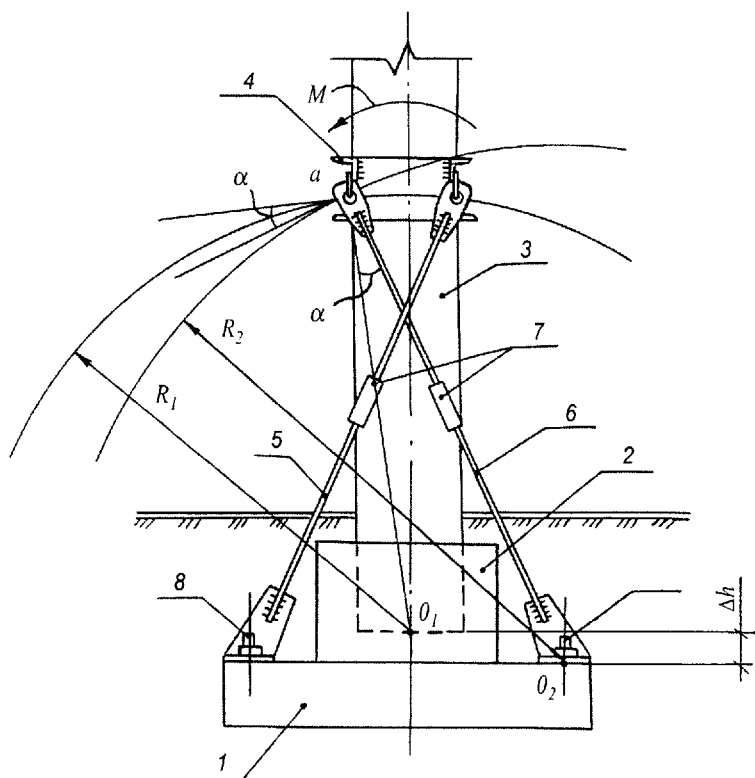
Схема усиления стаканной части фундамента под колонну с помощью перекрестных тяжей (связей): 1 – плитная часть усиливаемого фундамента; 2 – стаканная часть усиливаемого фундамента; 3 – колонна; 4 – обойма на колонне (железобетонная или металлическая); 5, 6 – металлические тяжи, устанавливаемые крест-накрест между обоймой и плитной частью фундамента; 7 – муфта натяжения; 8 – анкерные болты, устанавливаемые на цементном или полимерном растворе в высверленные отверстия
